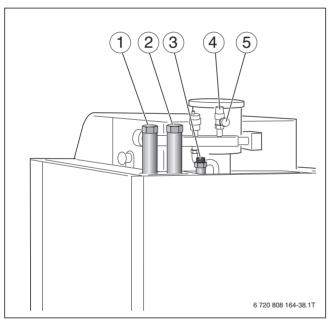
Rückansicht des Heizkessels (mit 3-Wege-Ventil)
